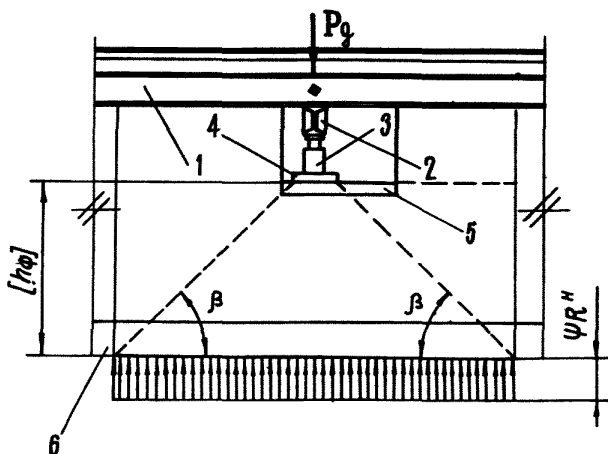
У.2. Схема нагрузок на ленточный фундамент в предельном состоянии при выправлении здания способом поддомкрачивания:
